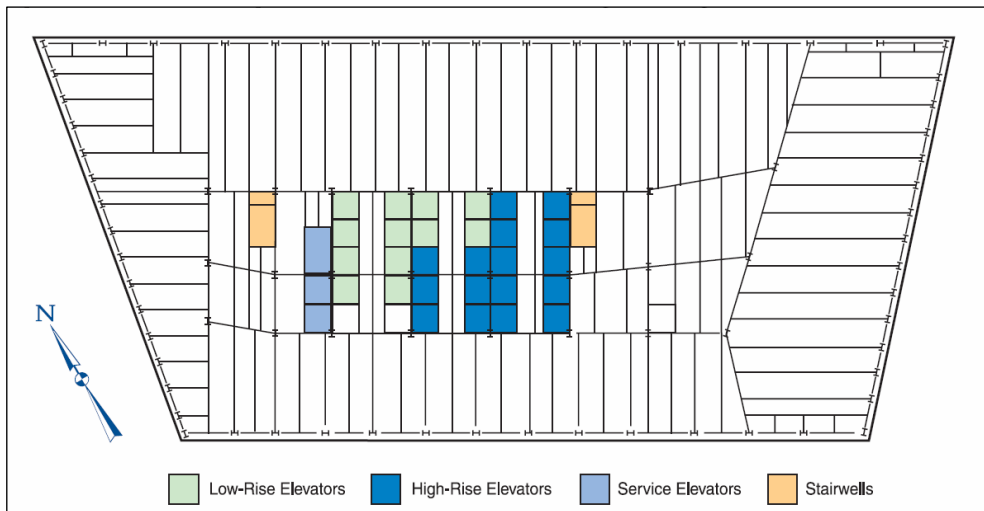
Pianta dell'impalcato tipo tra l'8° e il 45° piano
